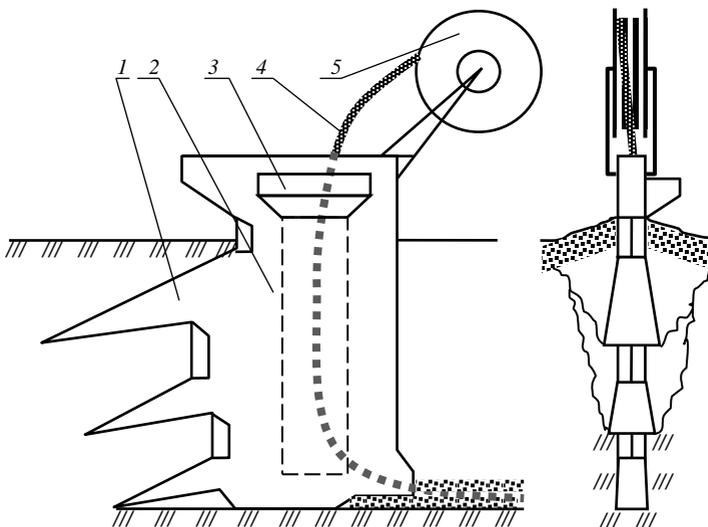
Схема рабочего органа дреноукладчика МД-13 со ступенчатым ножом: 1 – ступенчатый нож; 2 – рабочий орган; 3 – приемный раструб; 4 – дренажная труба; 5 – барабан
